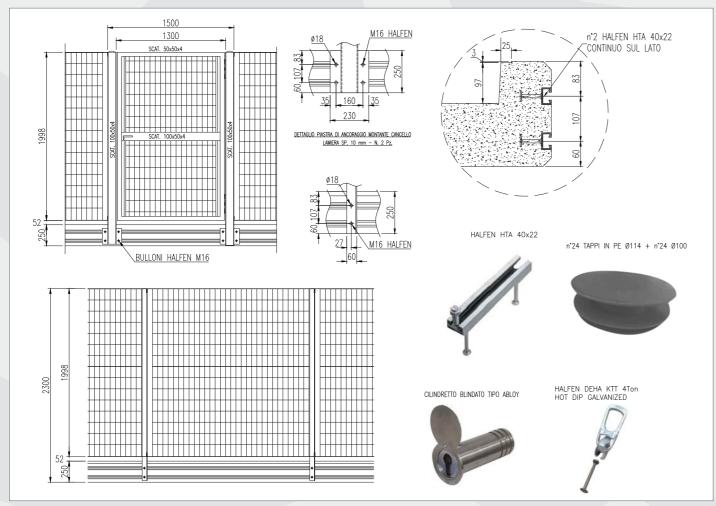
Recinzione FAST SITE® SYSTEM 30
